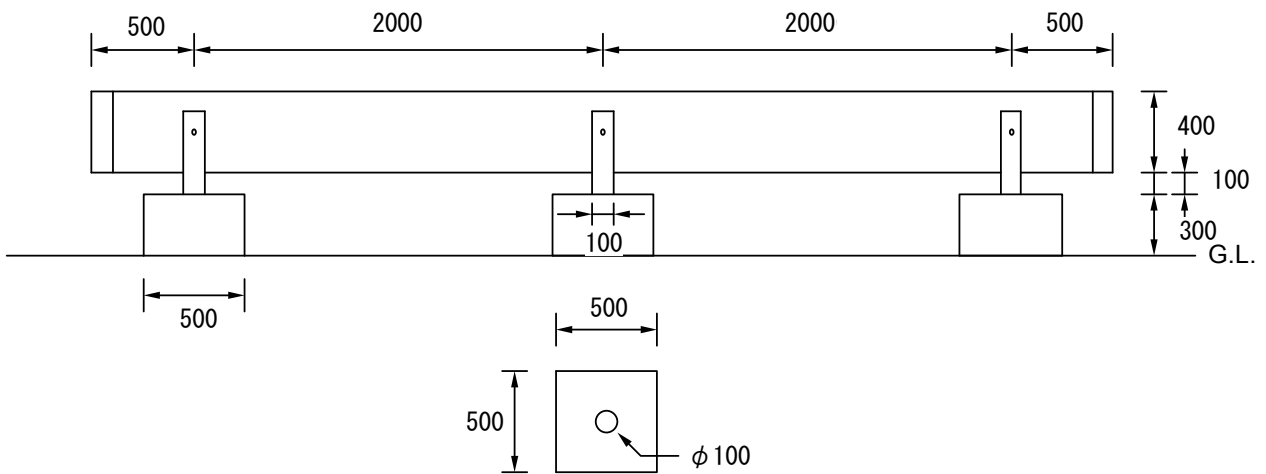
ガードレール立面図 (単位 : mm)
